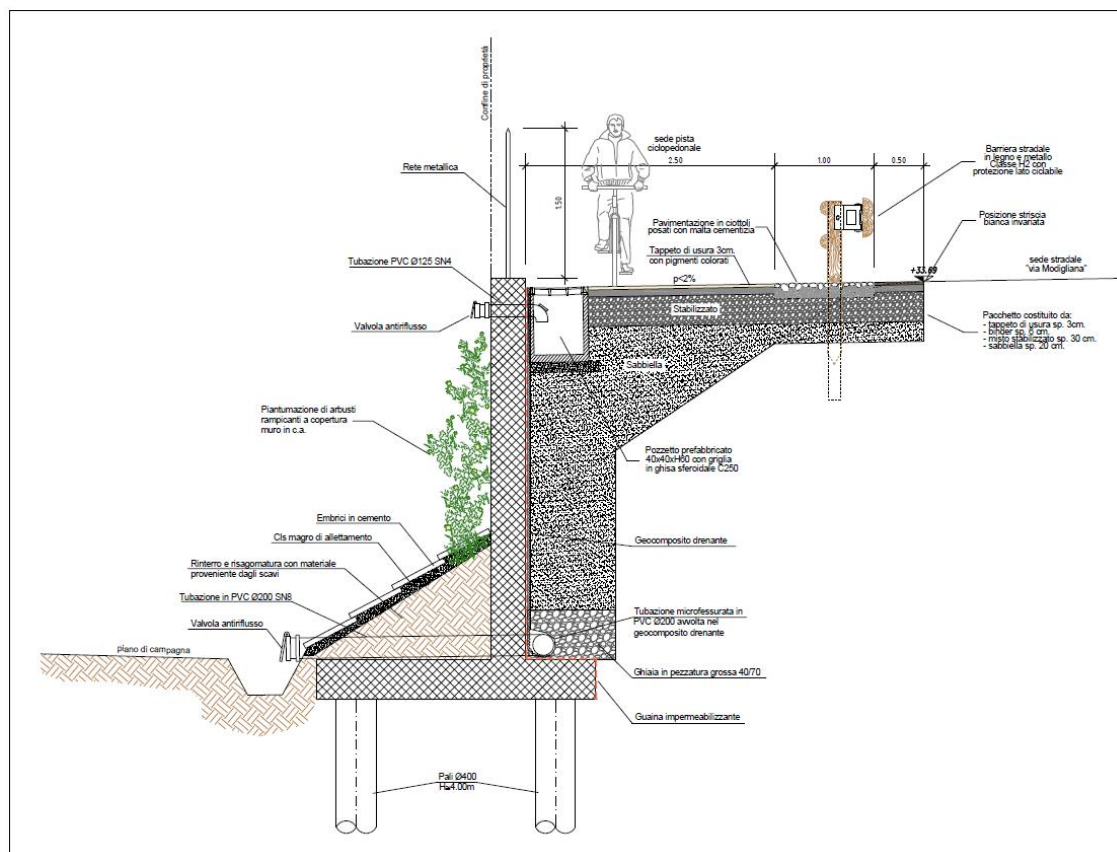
È Sezione Tratto 2 (lato Borgo Tuliero)
